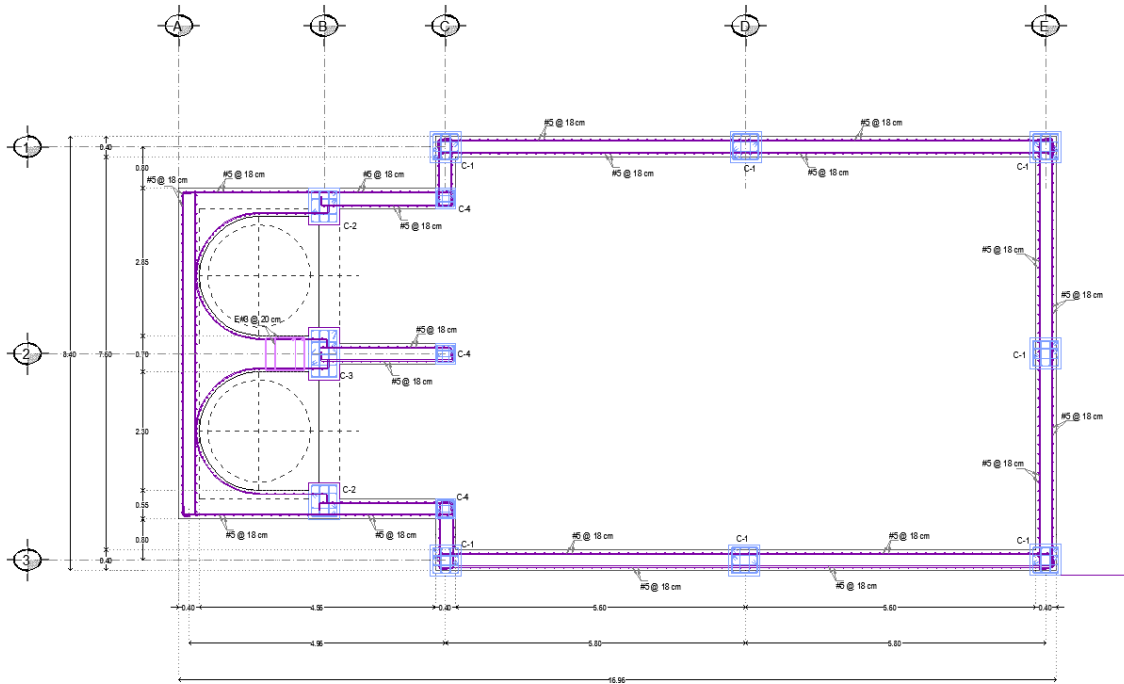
Arreglo de cimentación de bombas de pozo caliente (Vista en planta)
